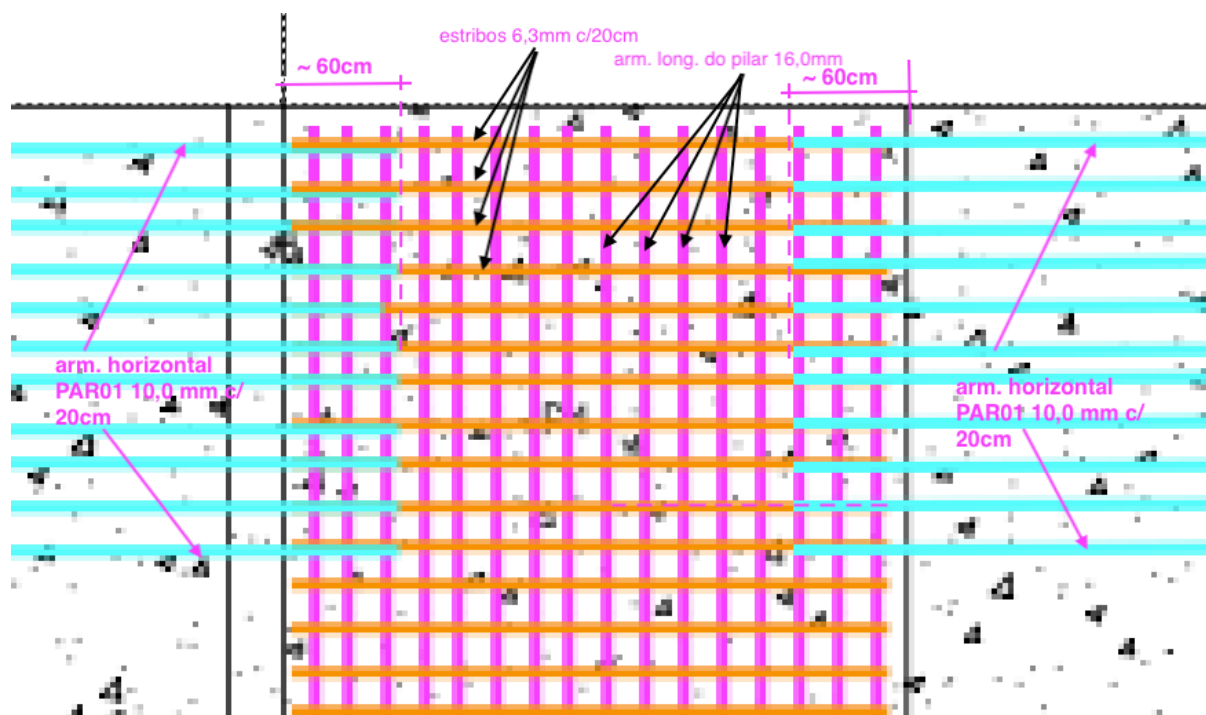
Esquema das armaduras encontradas na obra na união da parede PAR01 e PAR02 com o pilar P04.
